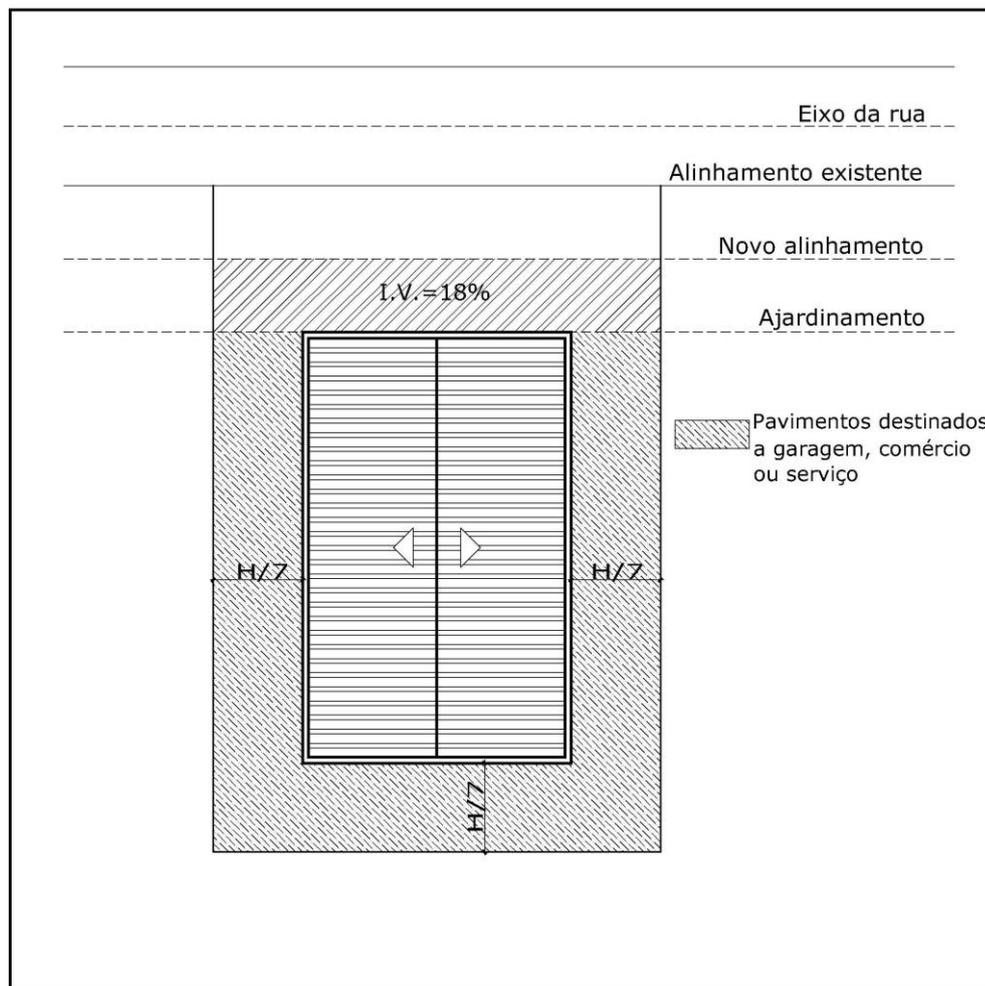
Afastamento em pavimentos destinados a garagem, comércio ou serviço.
